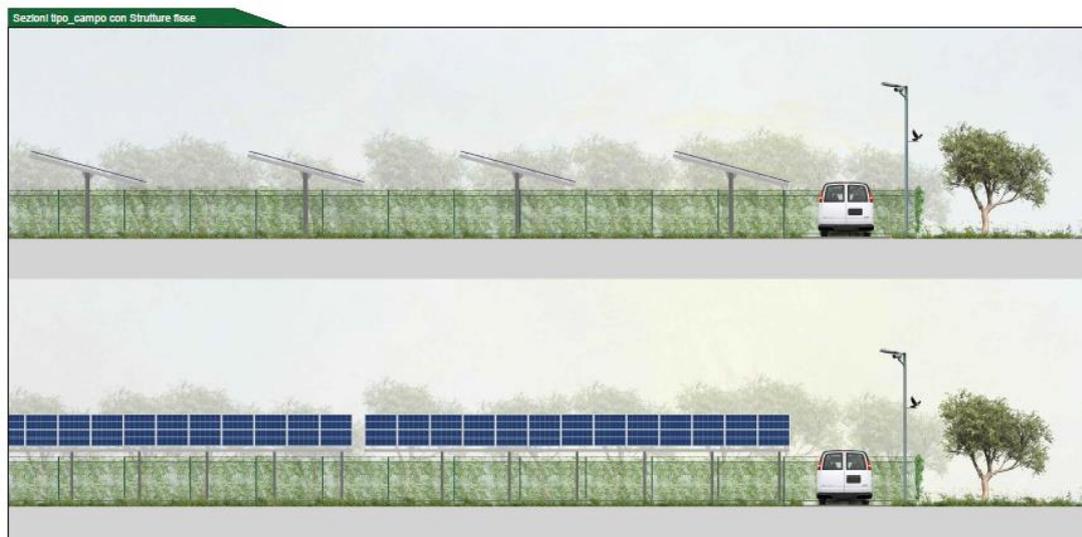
8 LAYOUT D'IMPIANTO- TAVOLA TKA855-PD-SEZIONI
